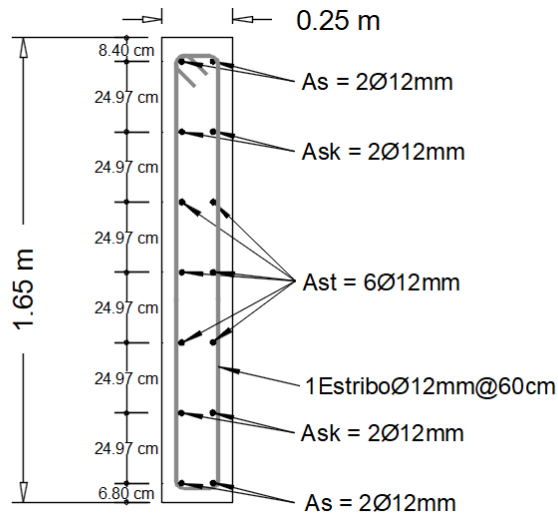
Sección del diafragma en la variante de vigas de hormigón postensado
